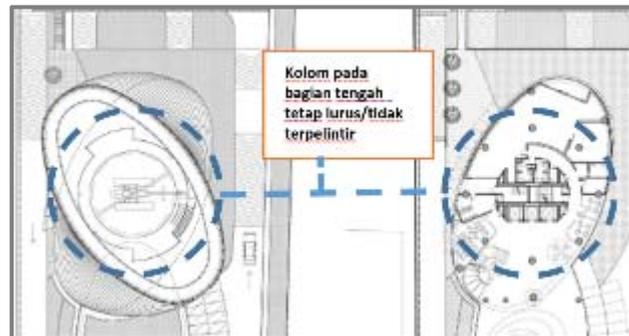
Layout* bangunan yang berputar sebesar 60 derajat
